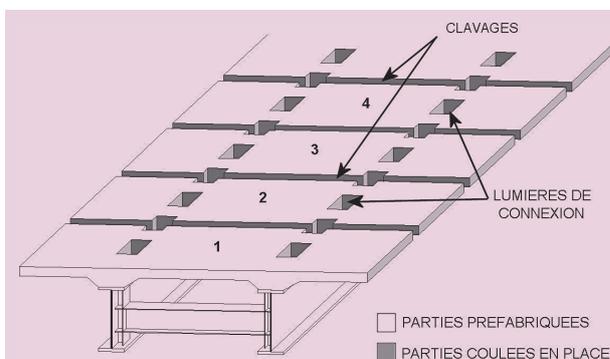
Répartition préfabrication/coulage en place pour un bipoutre à entretoises
